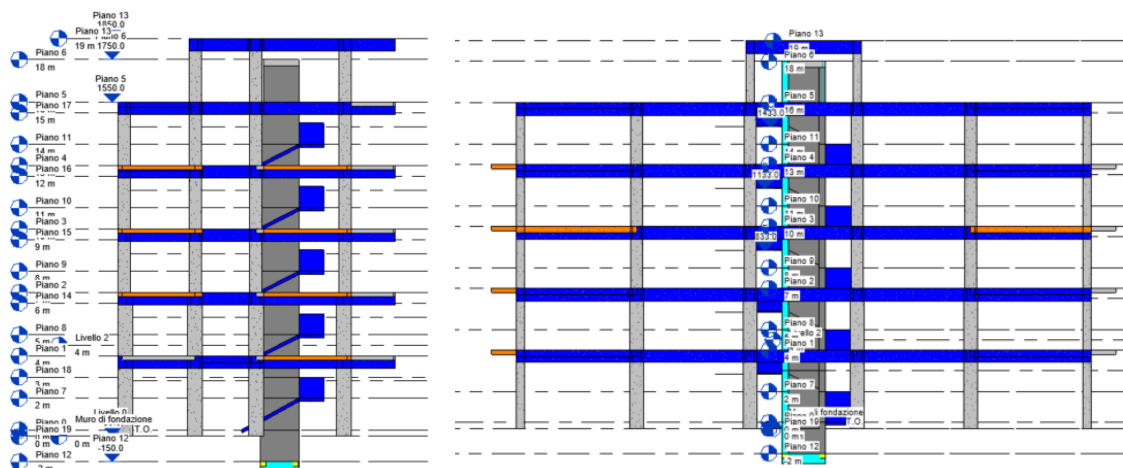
Vista 3D della struttura modellata su Revit, completa di balconi e scale.
